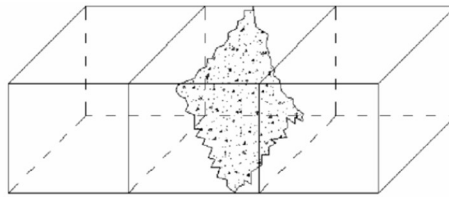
Permodelan Uji Kuat Lentur Beton
